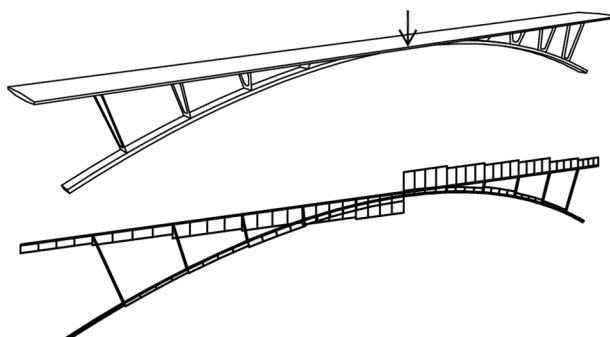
Prut šířky 1 metr vytknutý z konstrukce
